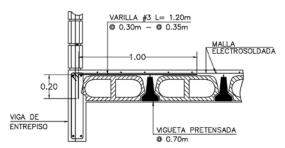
Detalle de refuerzo sísmico perpendicular a las viguetas
